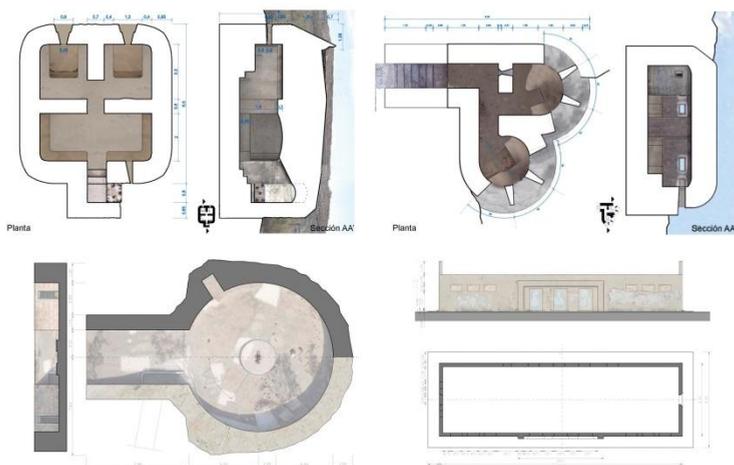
Planos de los estados actuales de un búnker de planta cuadrada y otro de dos senos en El Portixol (EP), y una batería de costa y un barracón militar en el Cabo de Santa Pola (CS).
